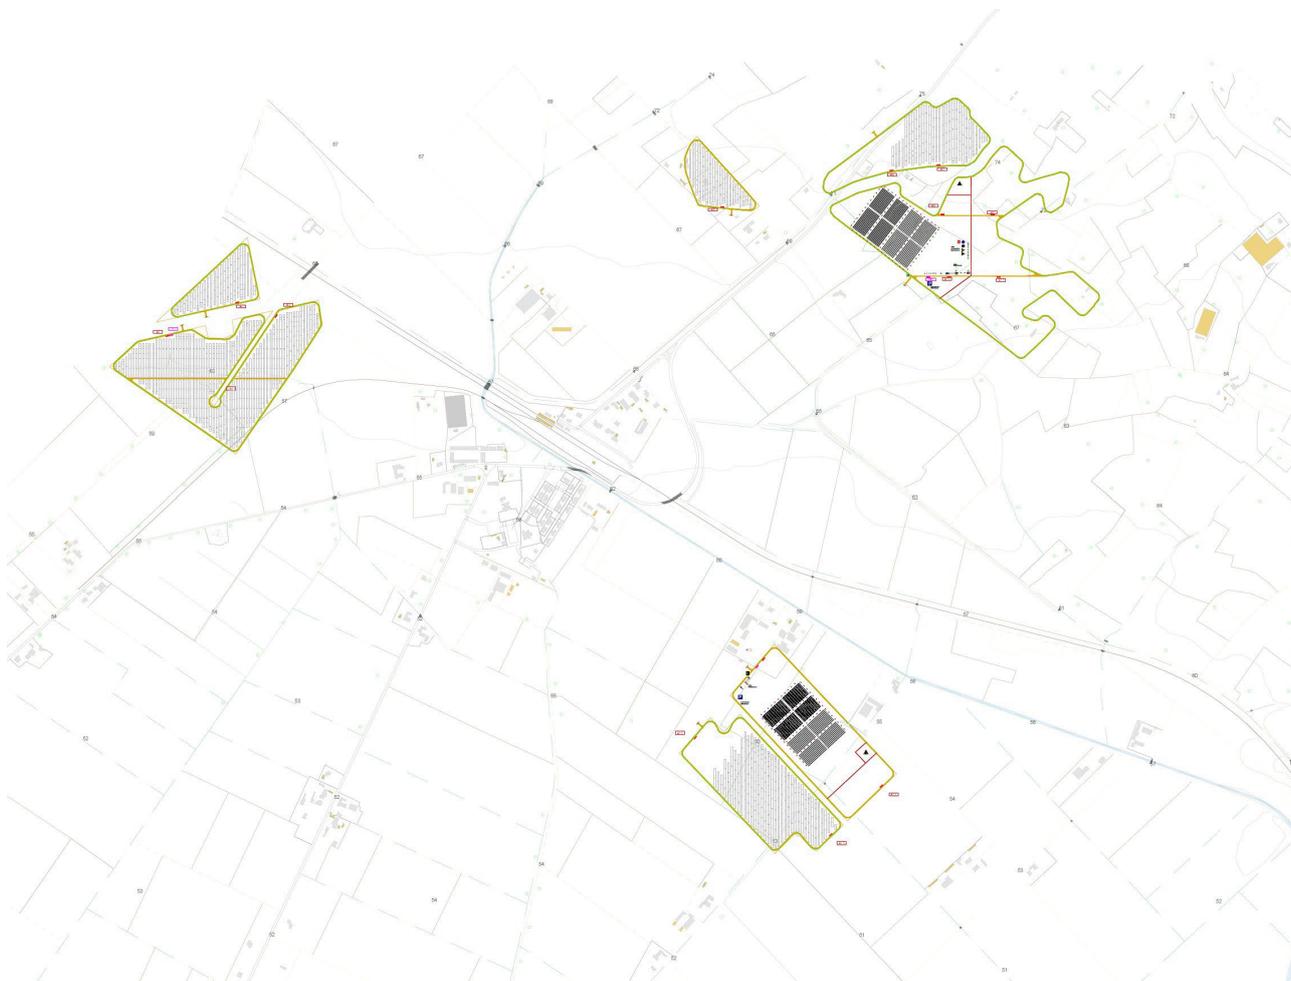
Ricezione, stoccaggio e movimentazione, cantiere 2
